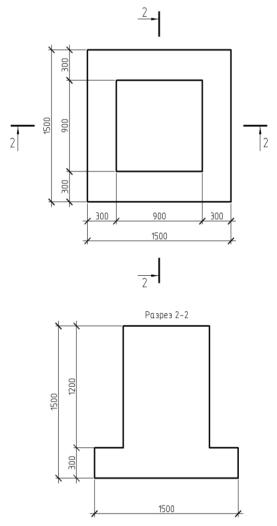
Пример оформления опалубочных чертежей отдельного фундамента мелкого заложения
